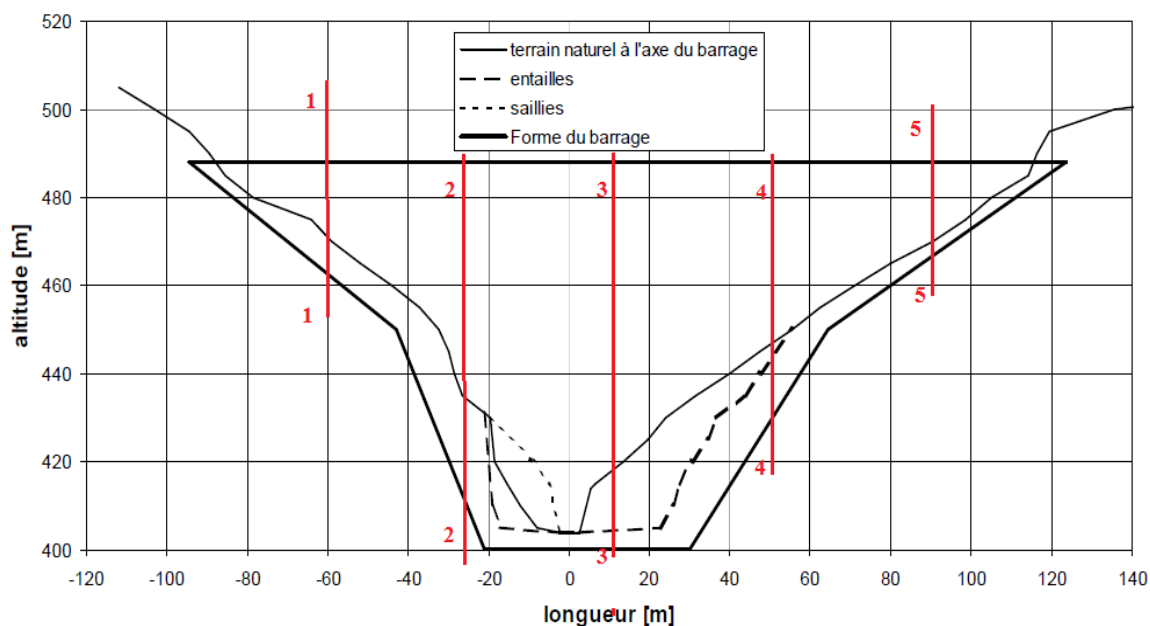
Profil longitudinal et coupes du barrage, Source [ANBT]
